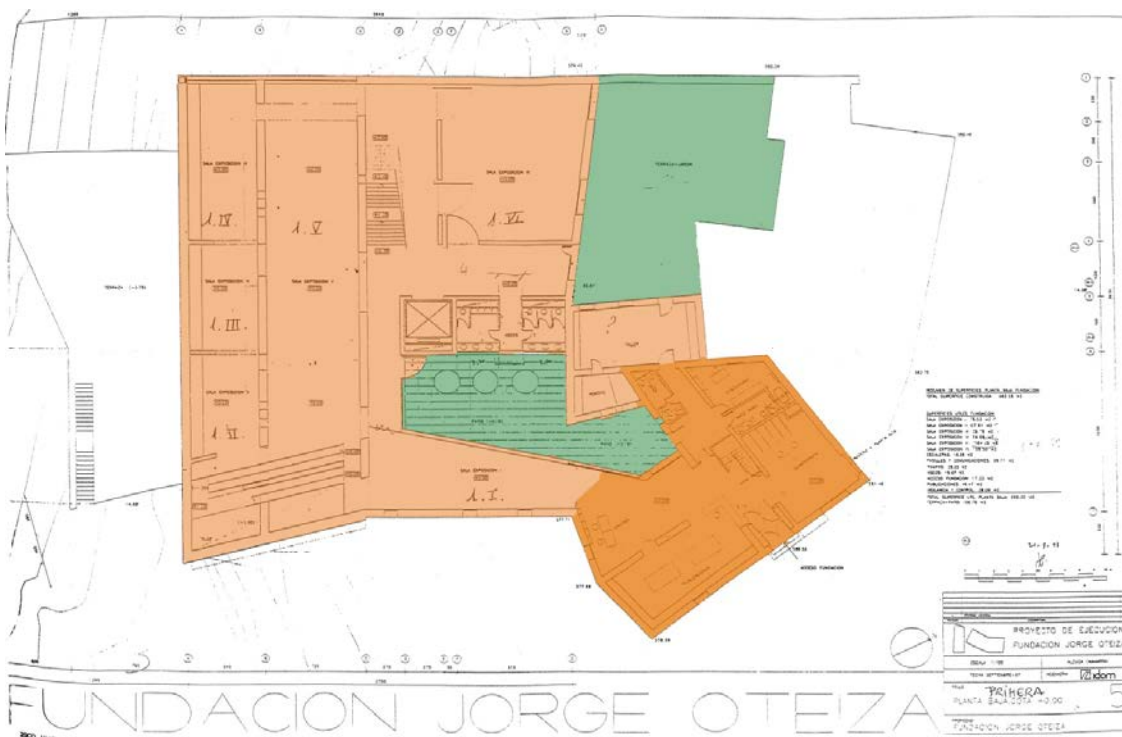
Planta 1, Fundación Jorge Oteiza. ■ exposición ■ patio ■ acceso fundación. S/E
